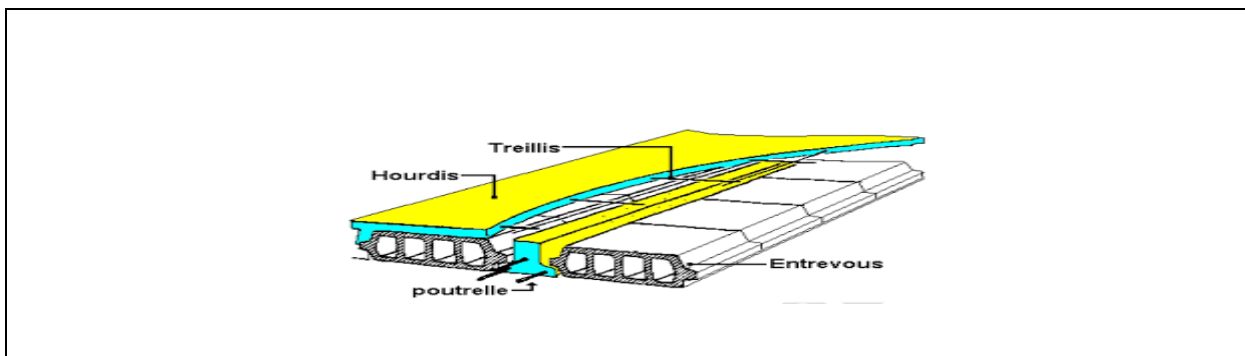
Plancher à corps creuxb) Planchers dalle pleine :
